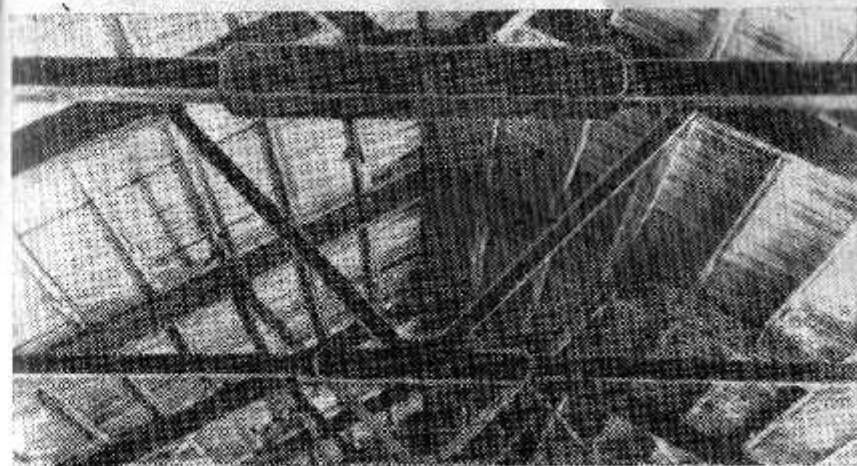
Общий вид покрытия с треугольными клееными фермами
